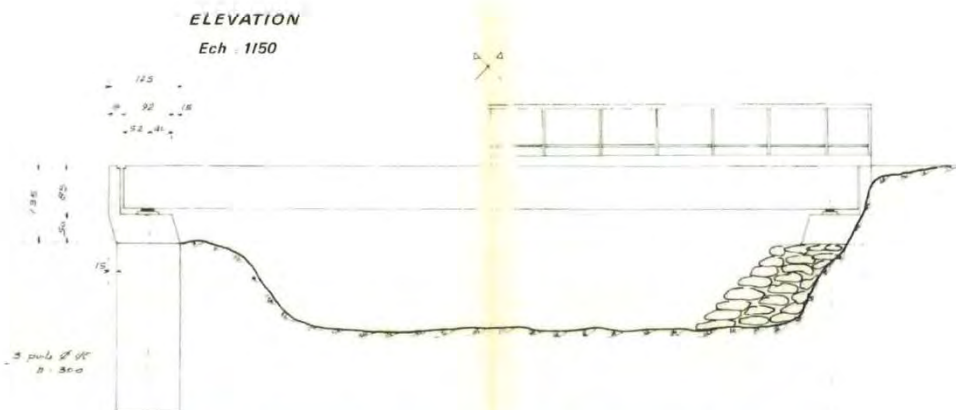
Plan d'élevation de l'ouvrage (Extrait du plan d'archives)
